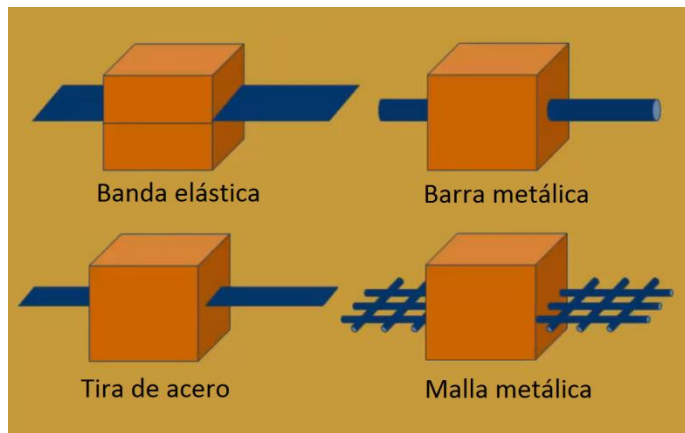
Ilustración tipos de refuerzo. Adaptada Kitch (2012).
